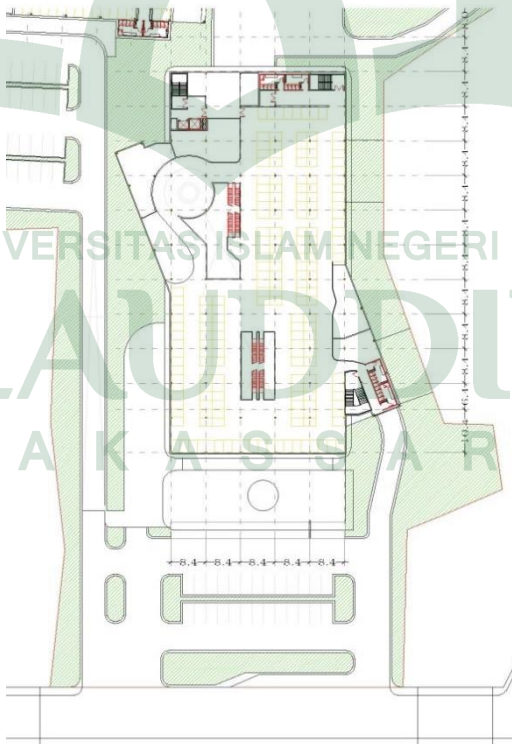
Denah lantai 2 area pedagang harian zona kering
